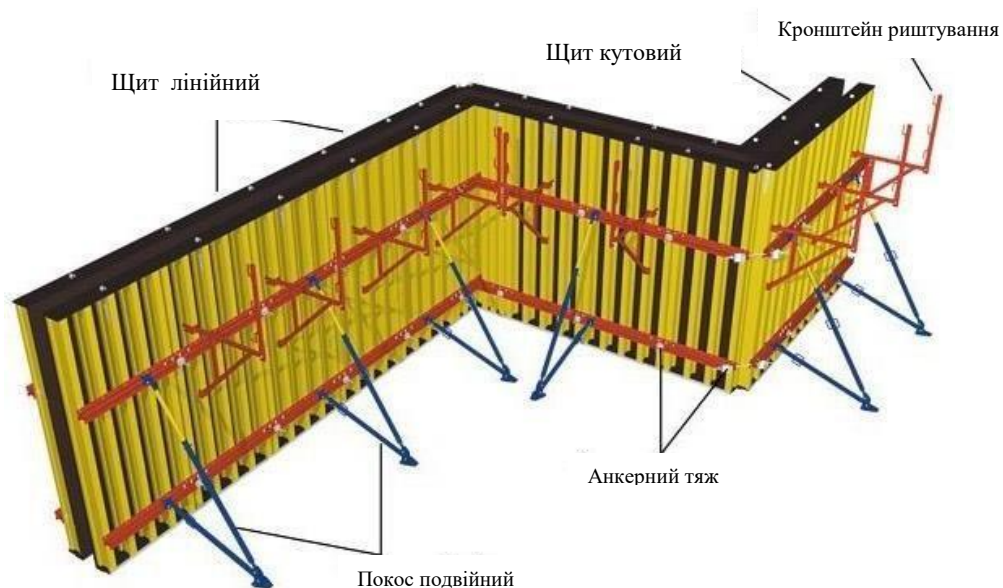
Балково-ригельна опалубка
